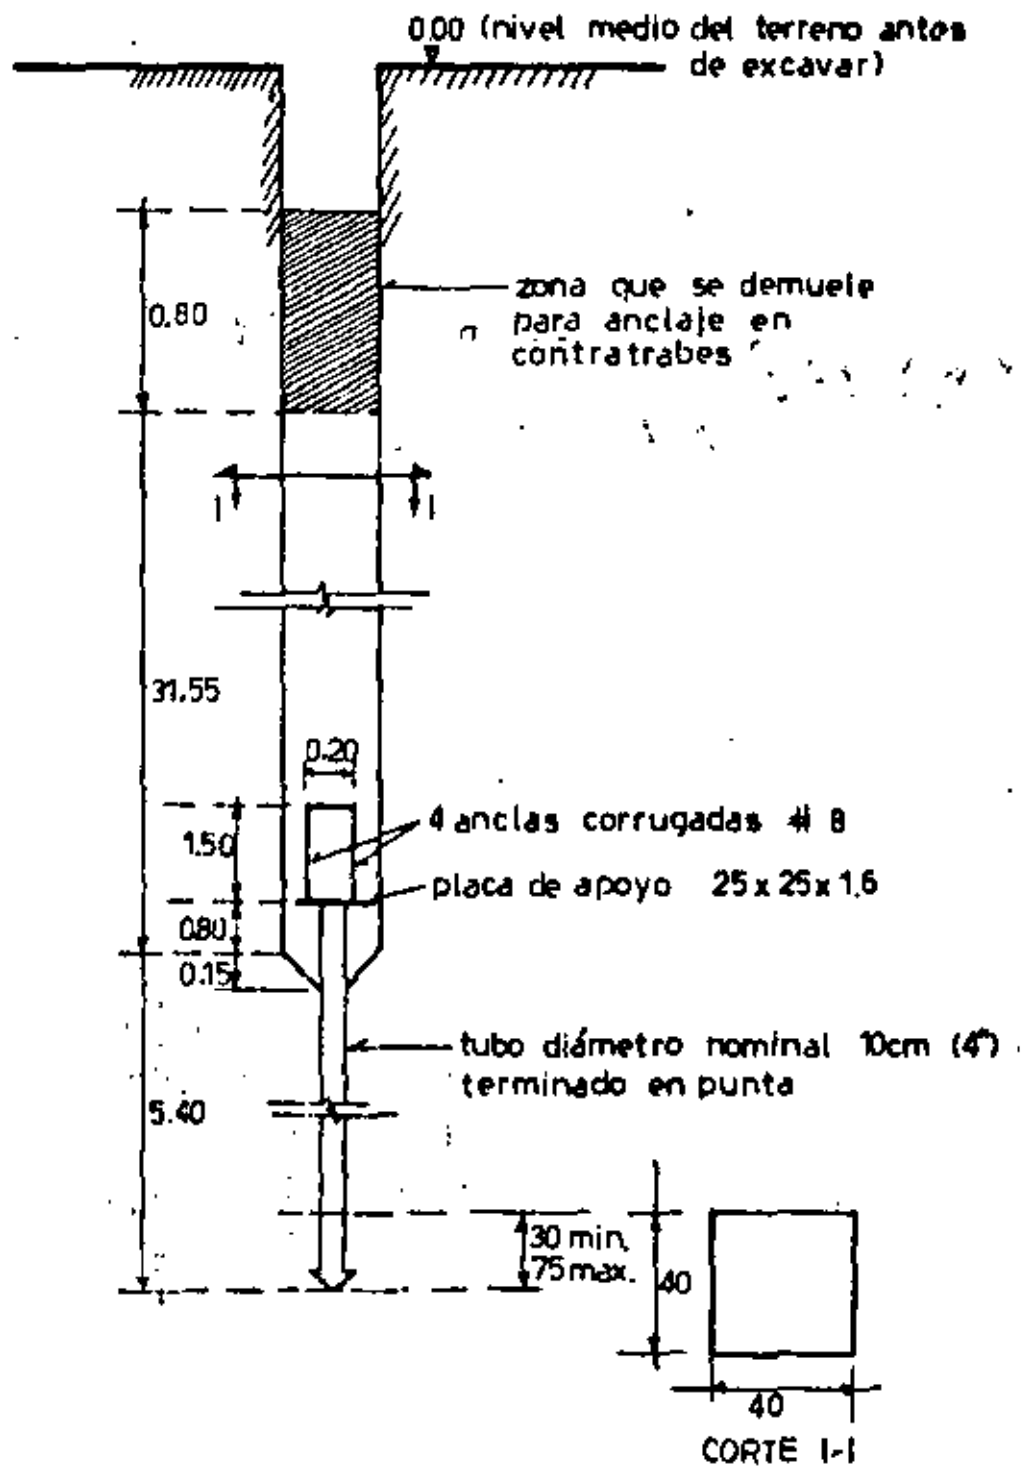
GEOMETRIA DE LOS PILDOTES DE LA CIMENTACION
